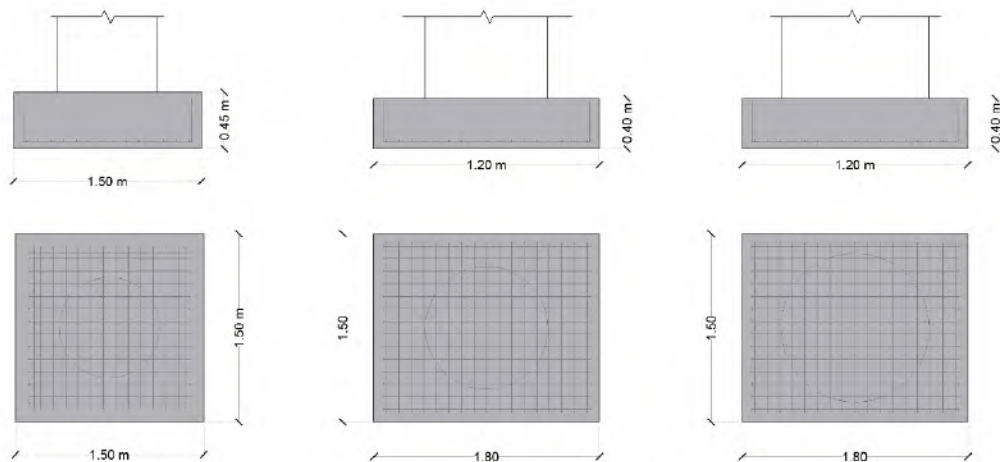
Representación grafica de zapatas aisladas Fuente: Elaborado por Ys.
